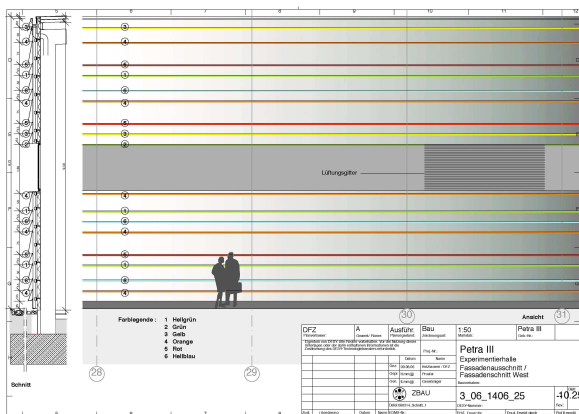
PETRA-III-Experimentierhalle, Plan der Fassade.
